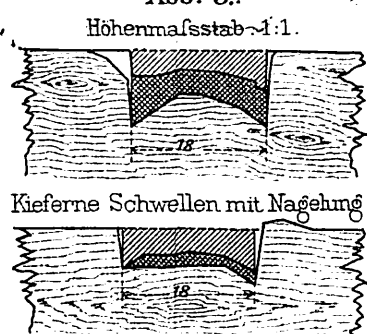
Kieferne Schwellen mit Schraubenbefestigung. Krümmung 750 m.
